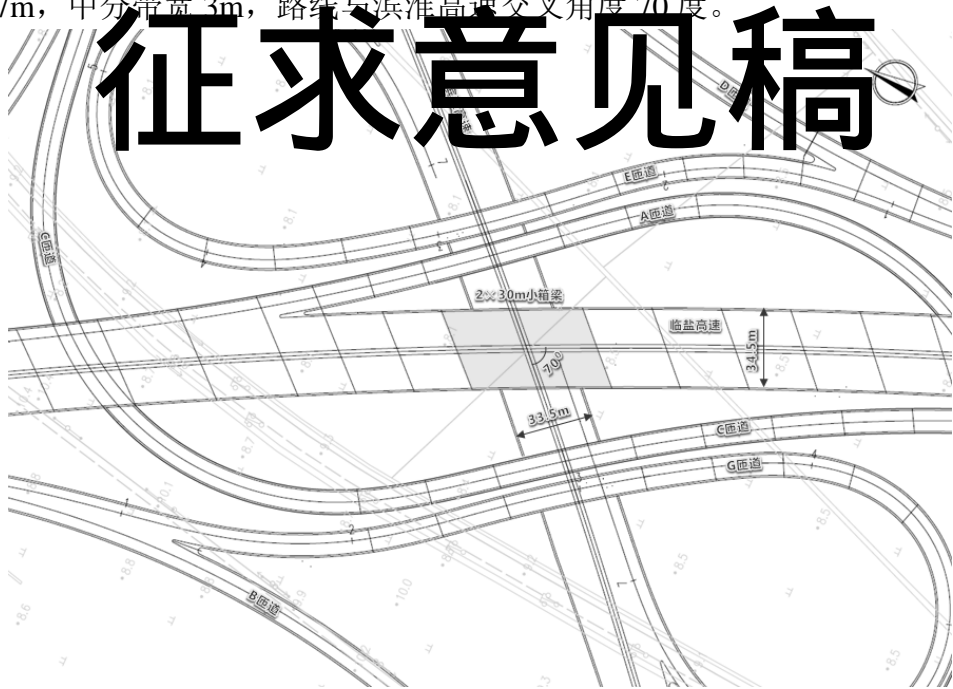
桥位平面布置图（尺寸单位：cm）
